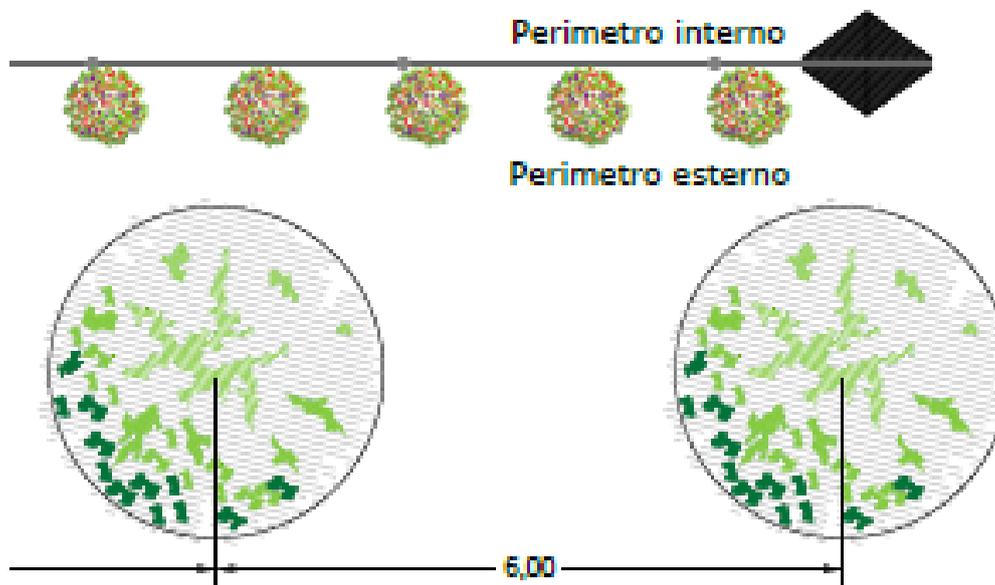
Stralcio planimetrico del sesto d'impianto della mitigazione
